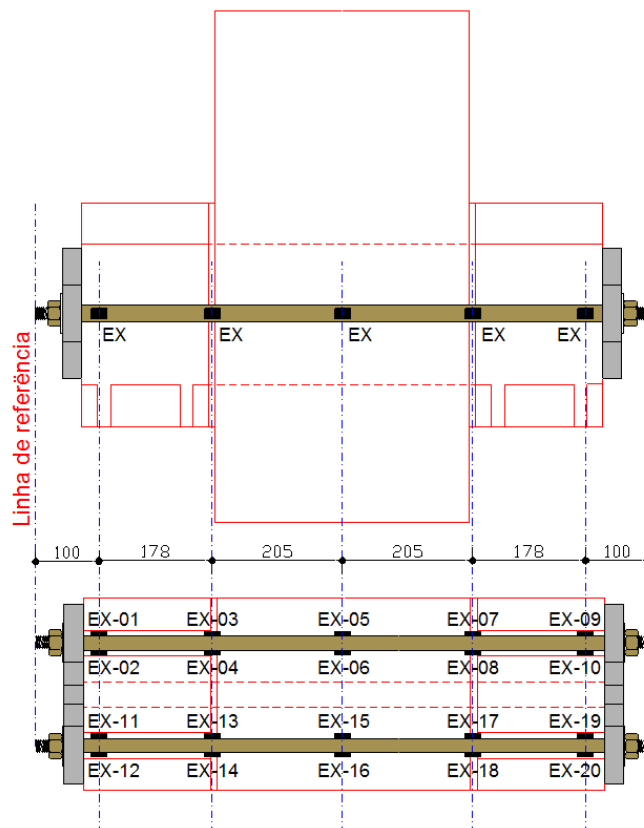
Instrumentação das armaduras para os modelos de chumbador - Aguiar, 2010 (dimensões em mm)
